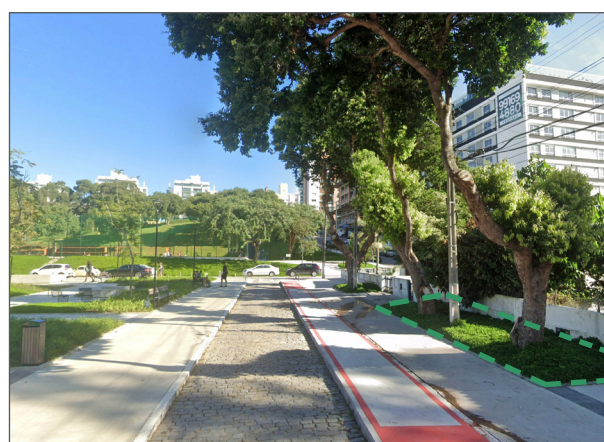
Adequação do perfil viário para implantação de canteiros para a arborização existente.
